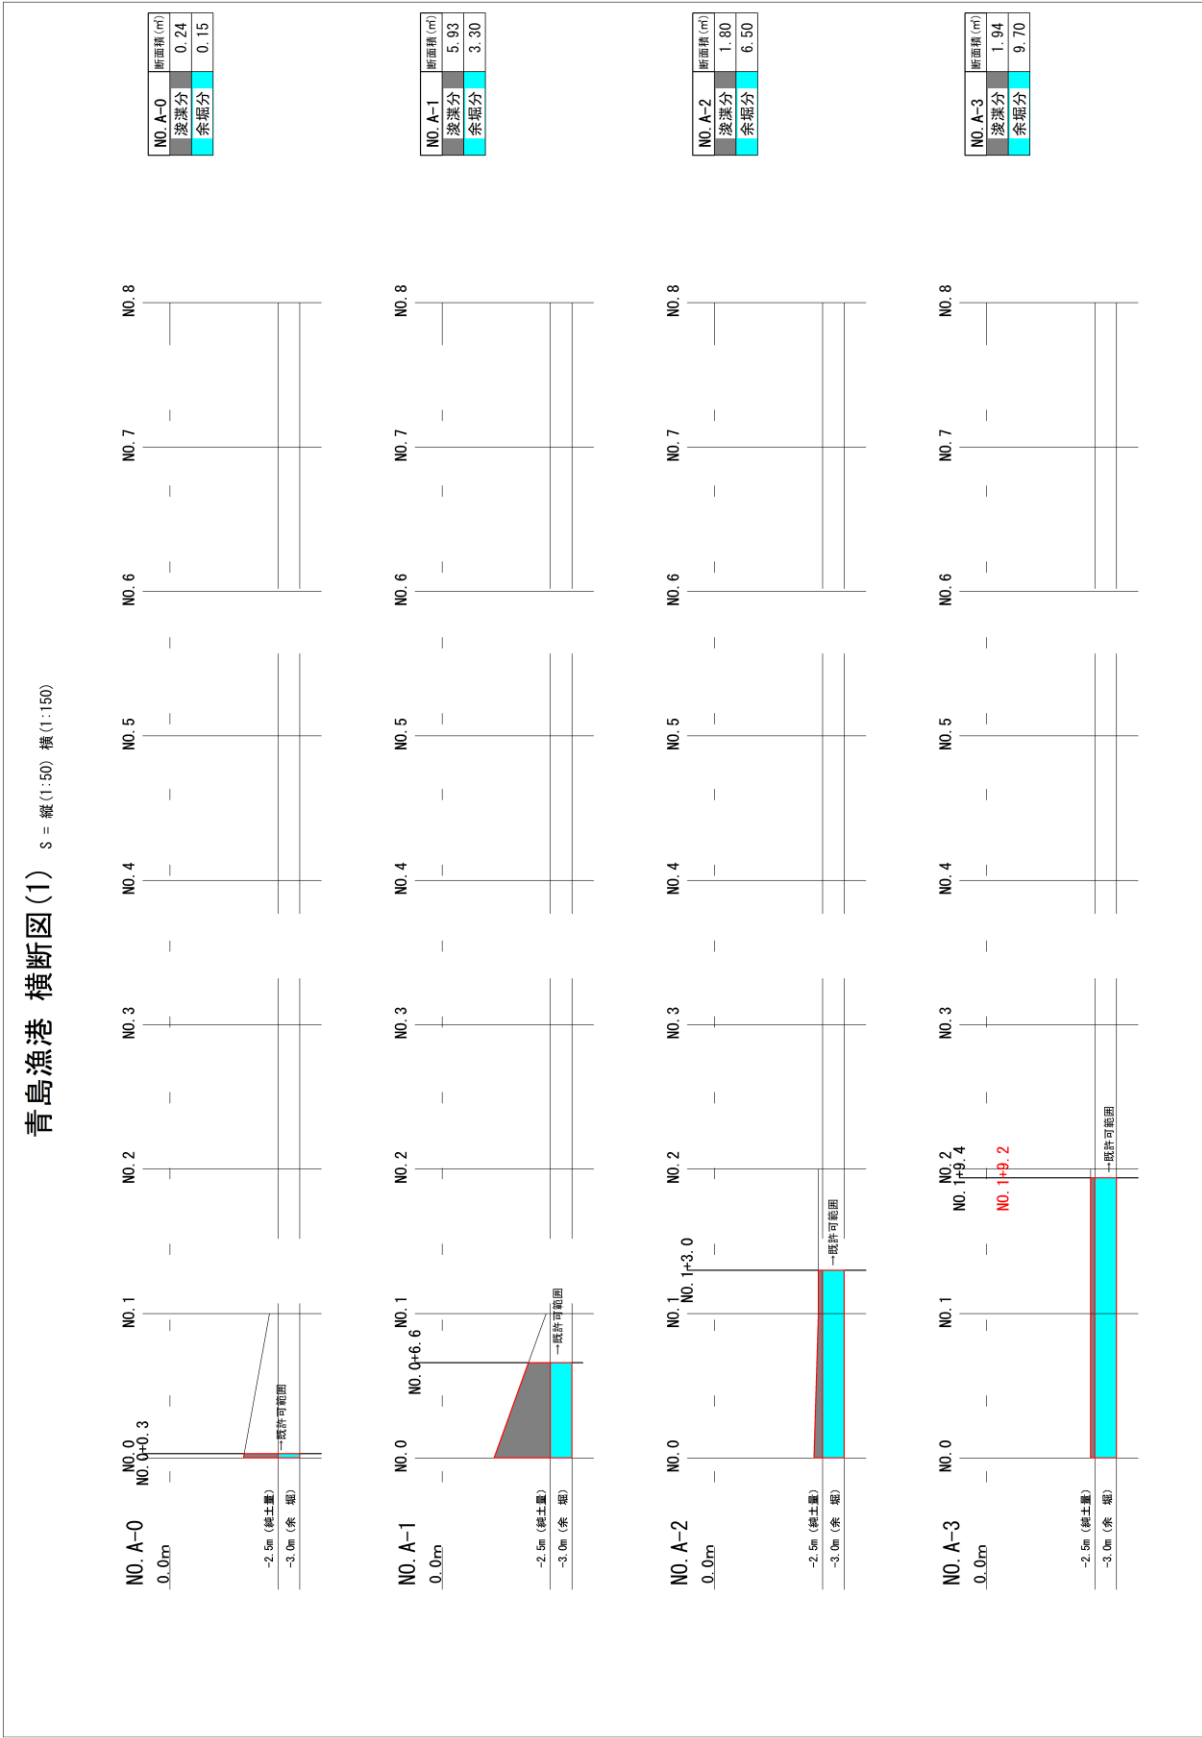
(1) 横断面図 (測線 No. A-0～A-3)
